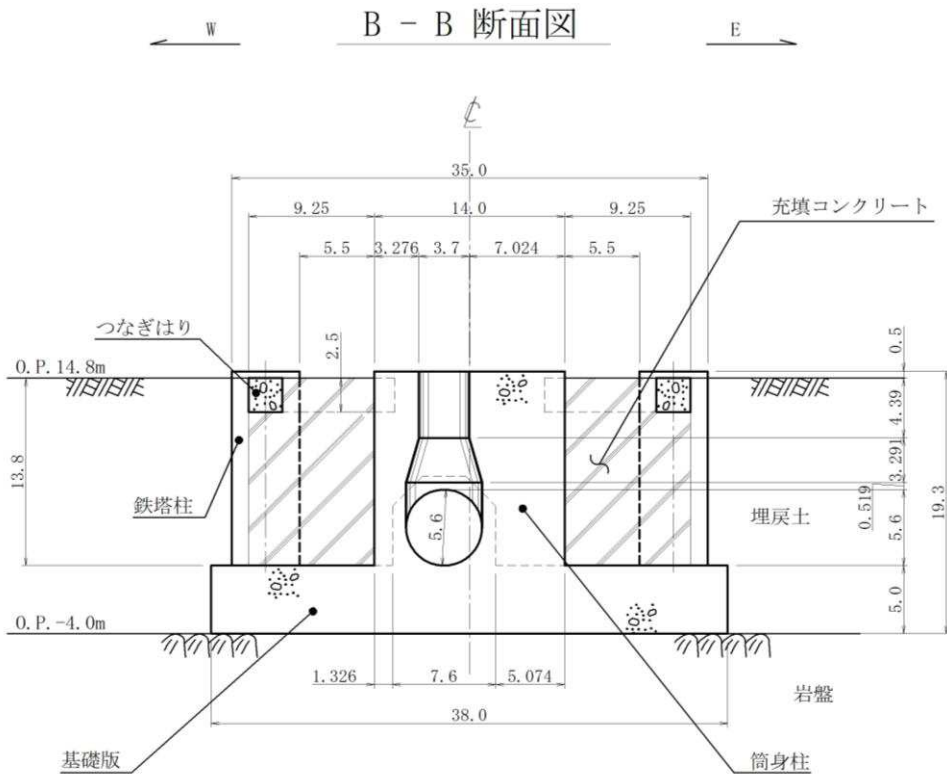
排気筒基礎断面図 (B-B 断面, EW 断面) (単位 : m)
